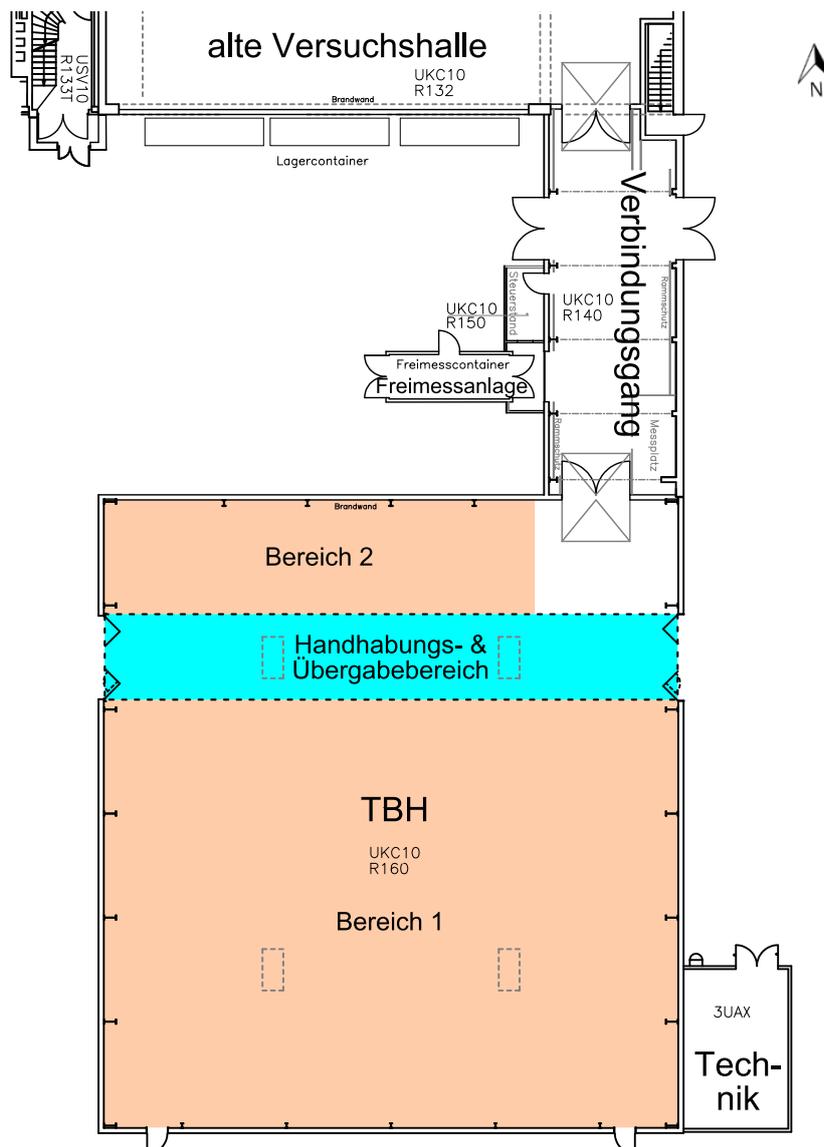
Grundriss der TBH mit angrenzendem Technikraum und Verbindungsgang zur alten Versuchshalle
